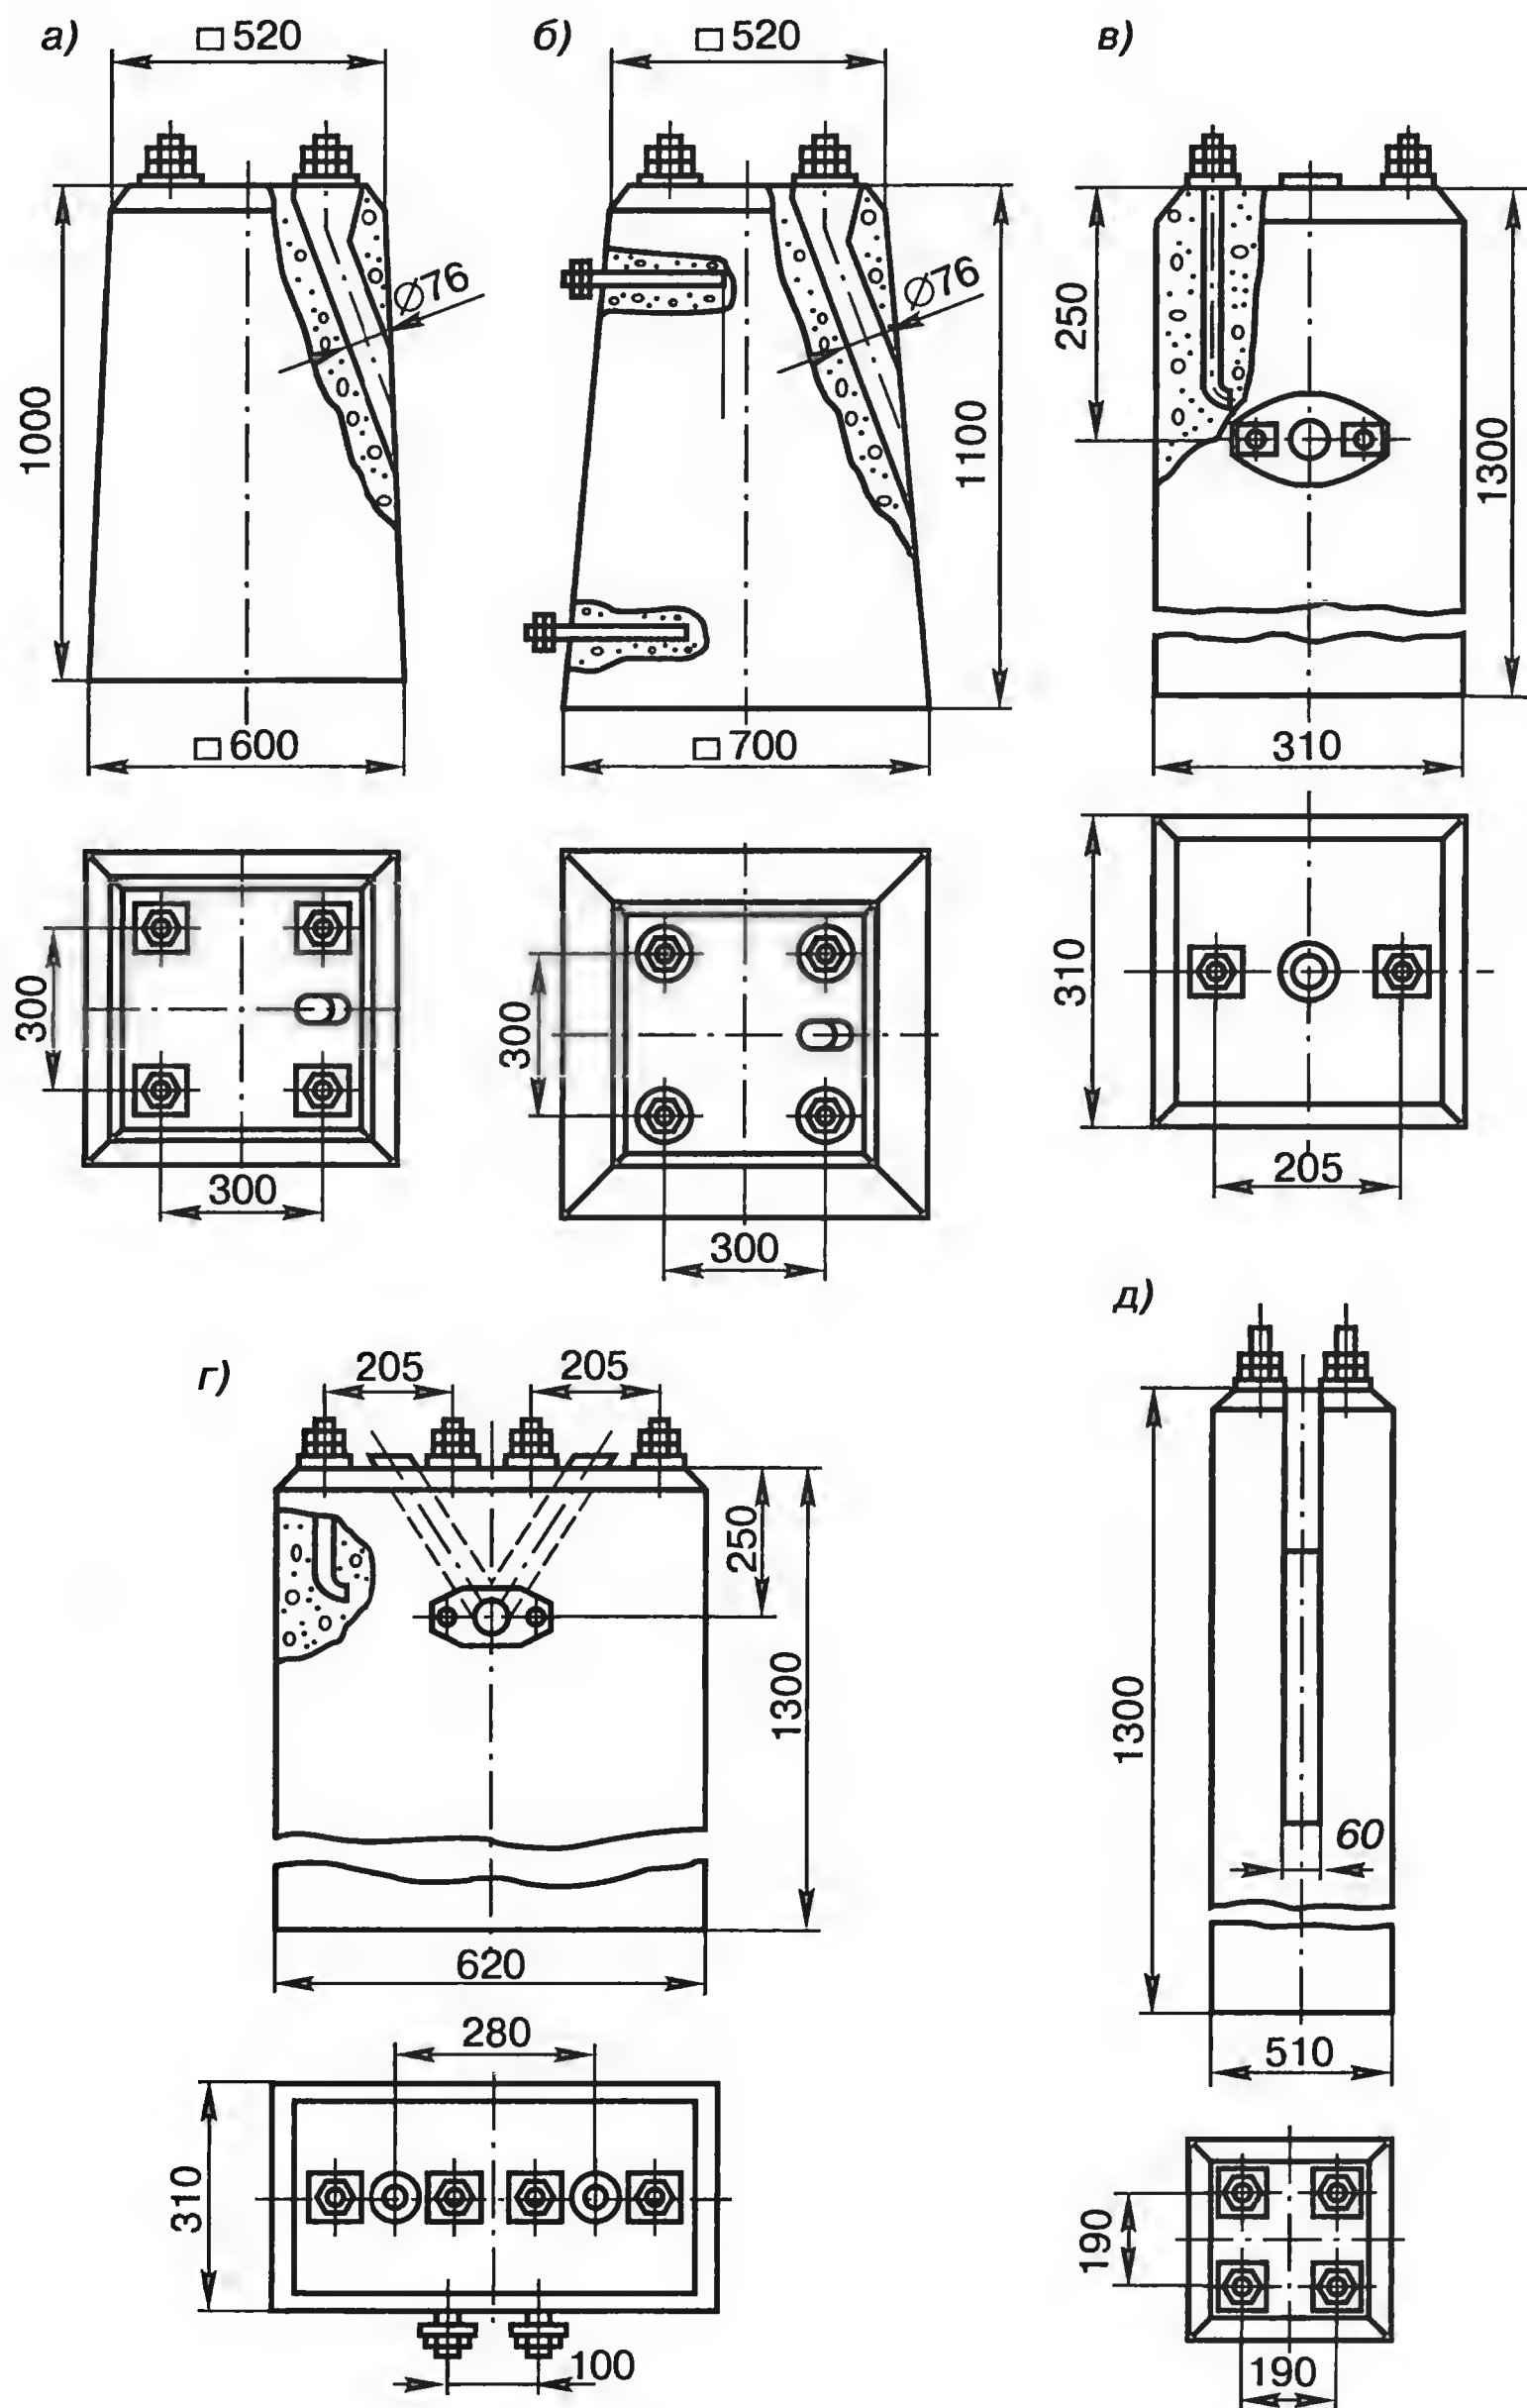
Фундаменты бетонные для установки светофоров и автошлагбаумов
